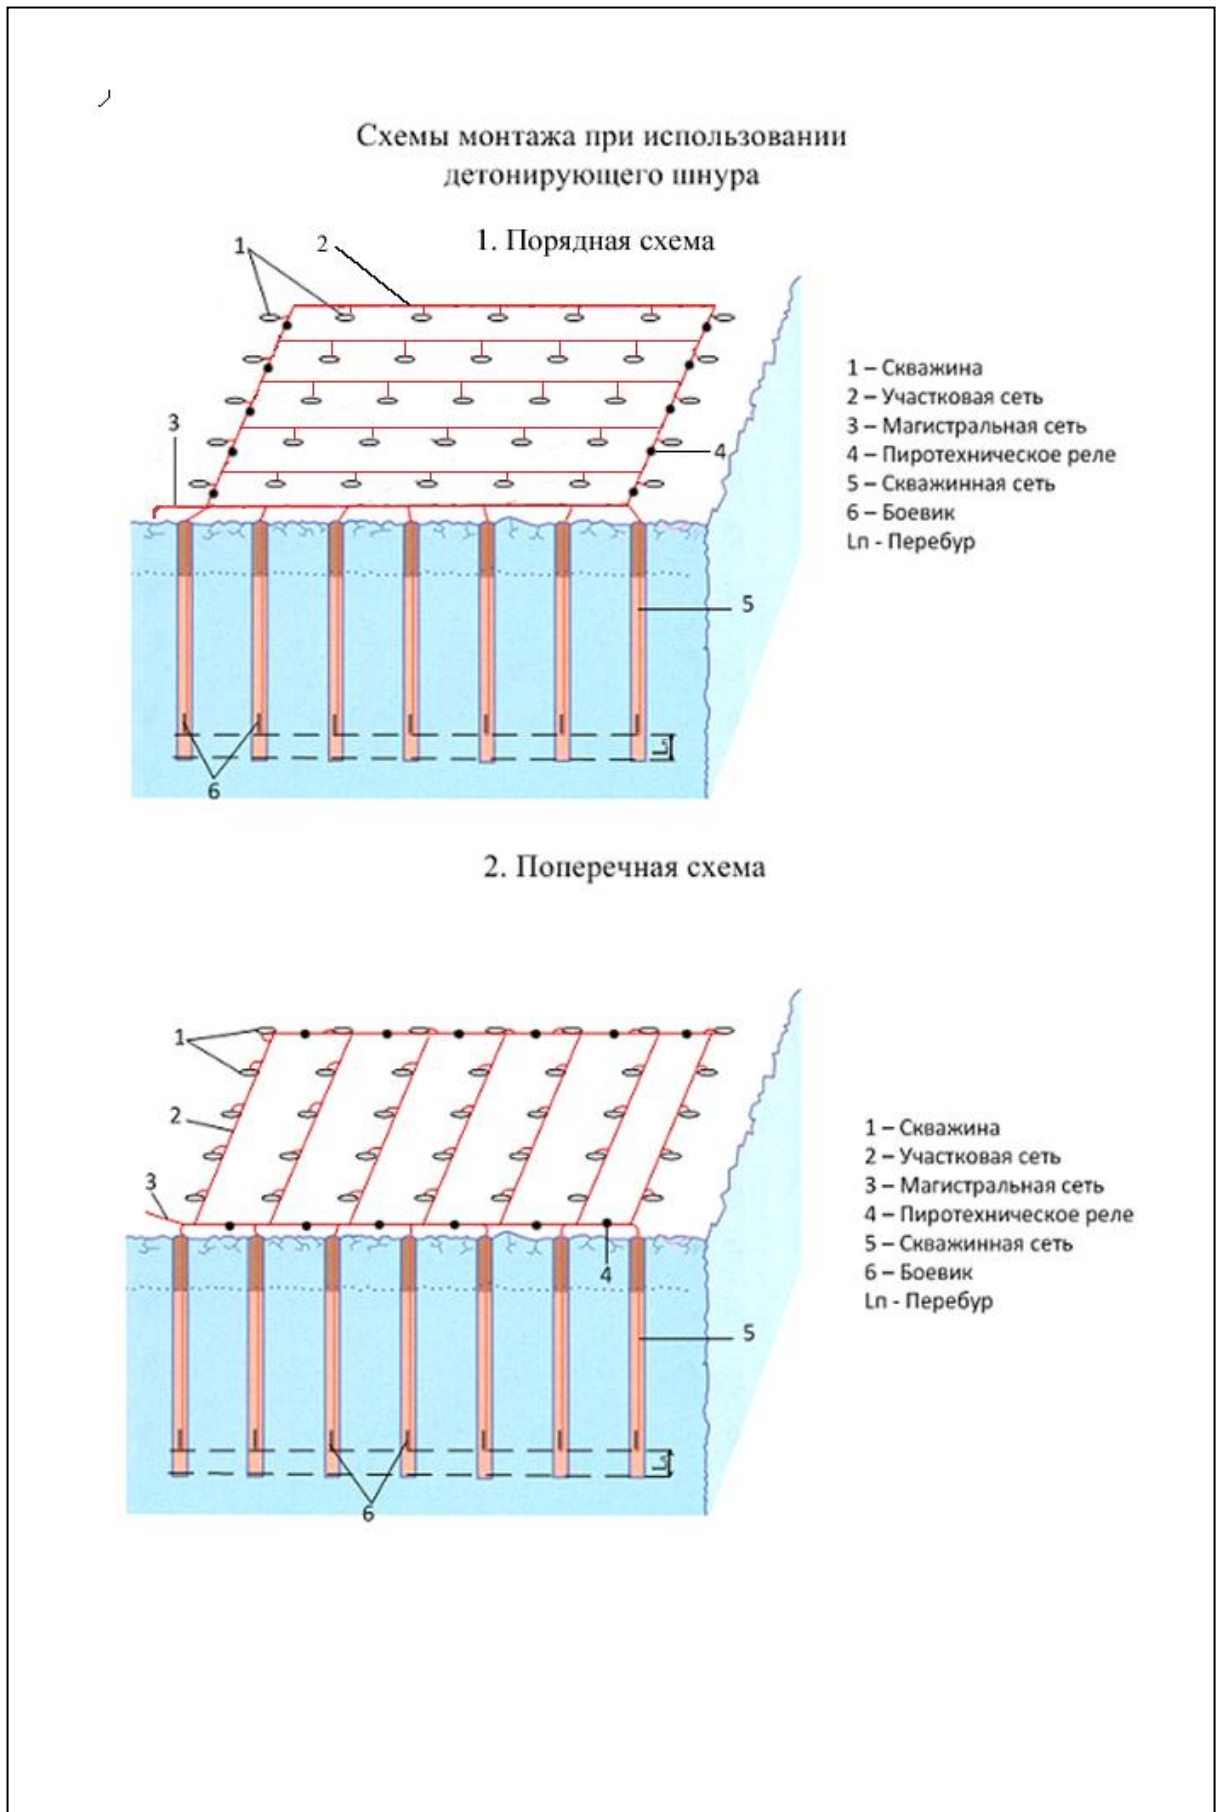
Порядная и поперечная схема монтажа взрывной сети
